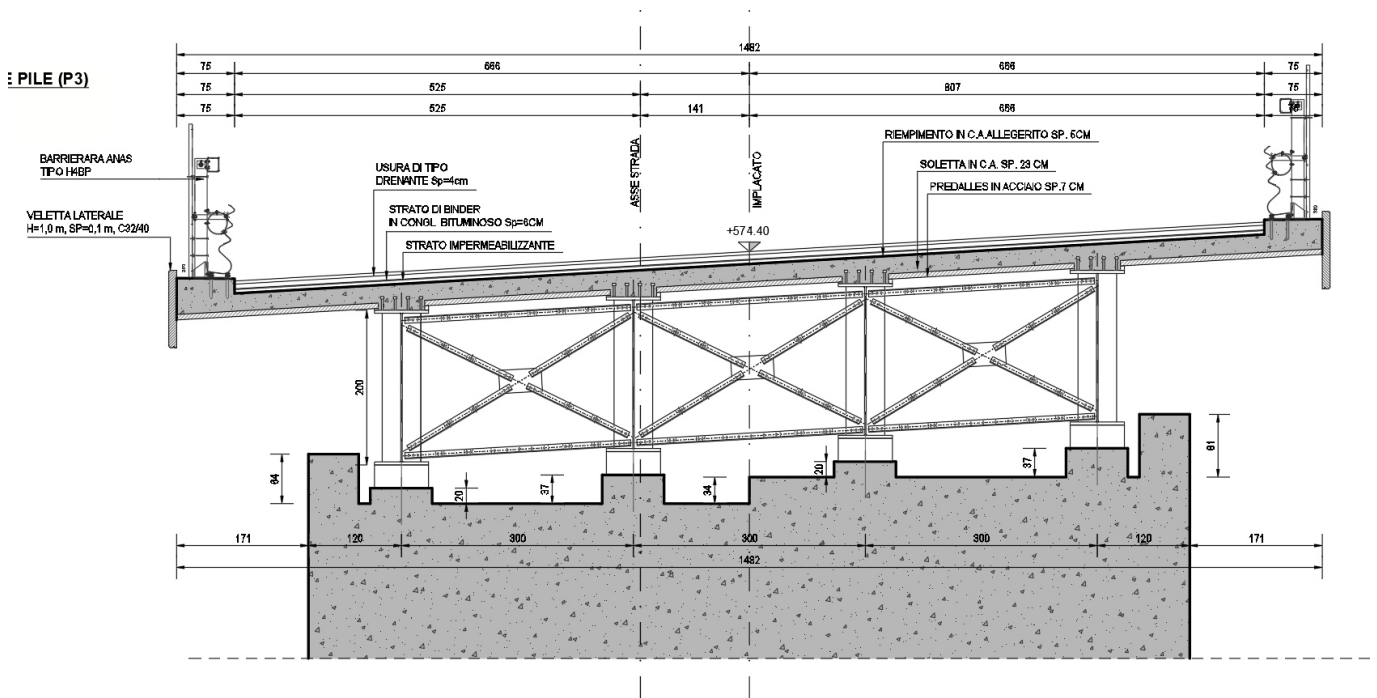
SEZIONE TRASVERSALE DELL'IMPALCATO IN PILA
